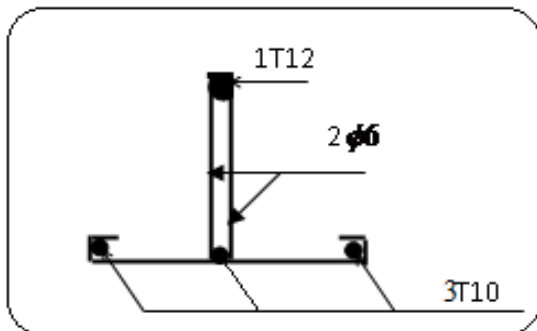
Schéma de ferrailage de la poutrelle type3.
